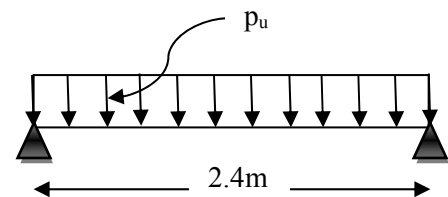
Schéma statique de la poutre palier du 3^{ème} Type d'escalier.
